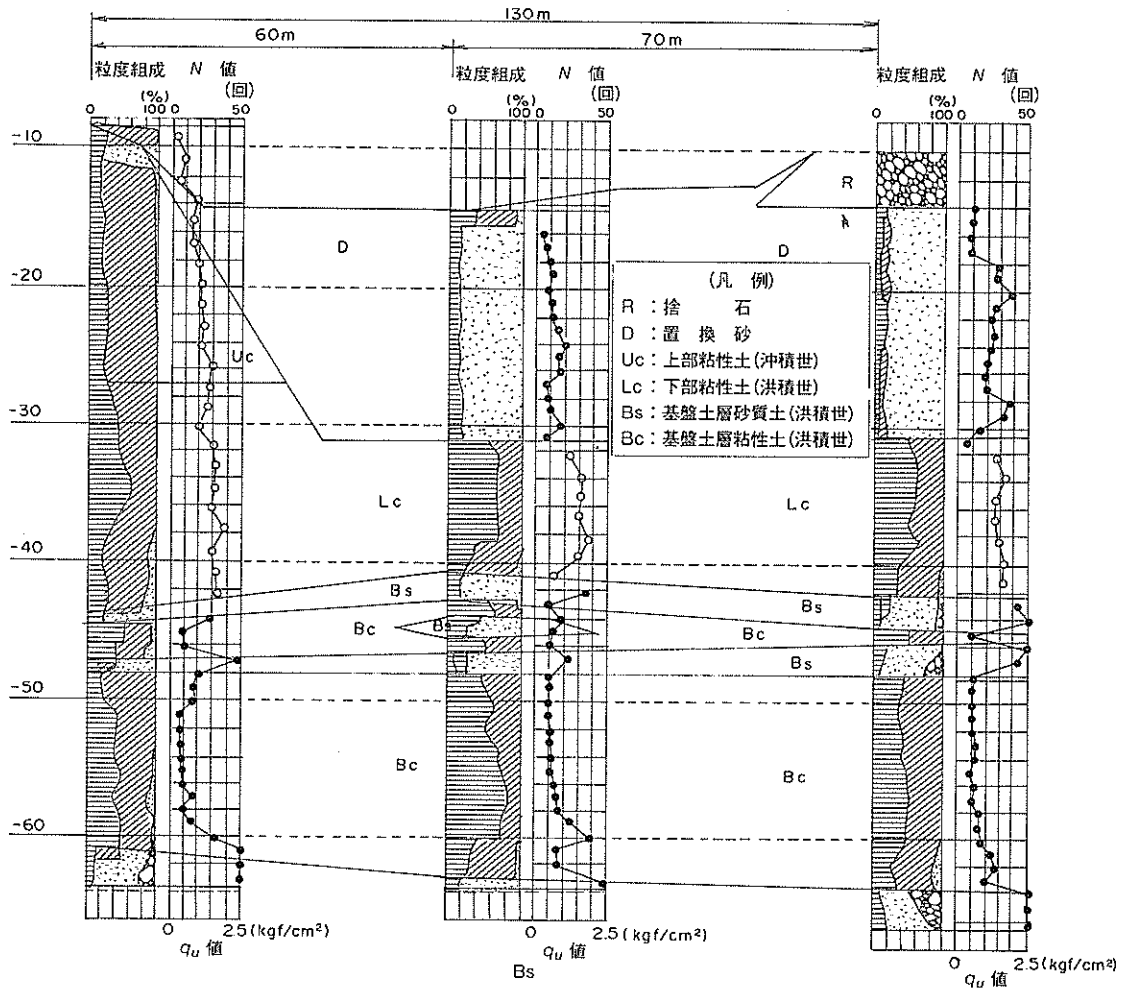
昭和南3号岸壁 (-7.5m)土質断面図
